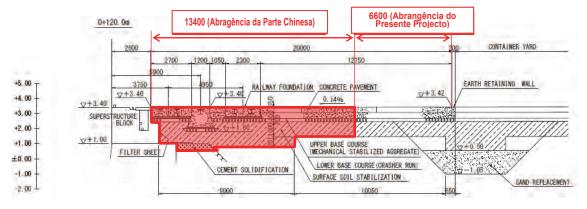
Abrangência do Pavimento do Cais (Proposta)
